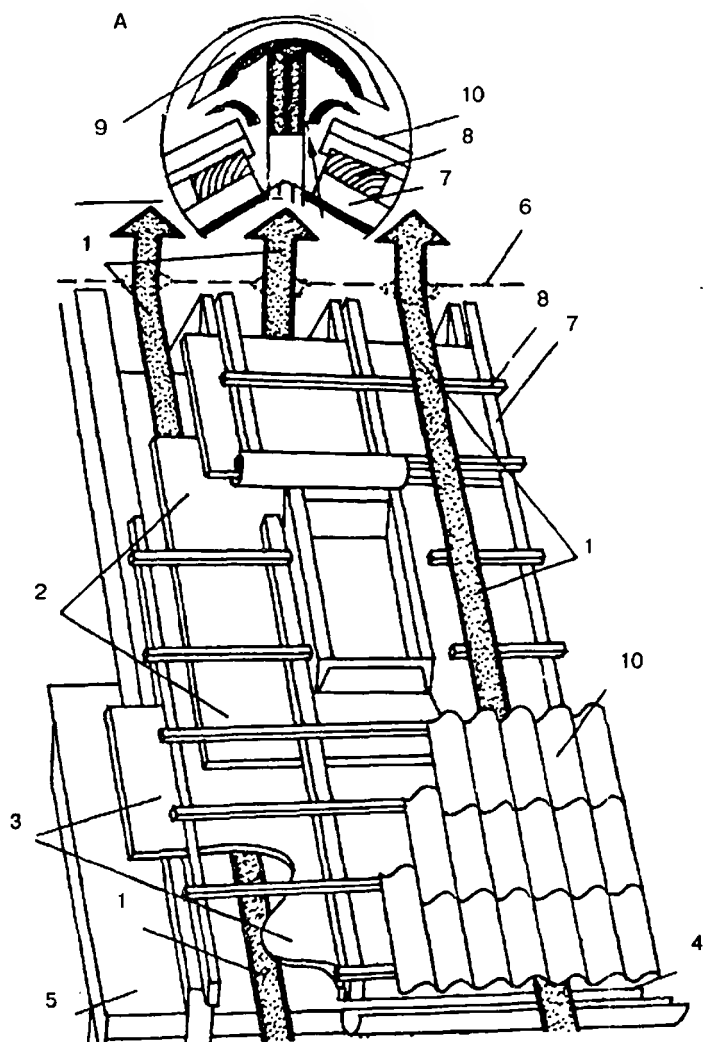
Конструкция крыши, обеспечивающая оптимальную вентиляцию:
